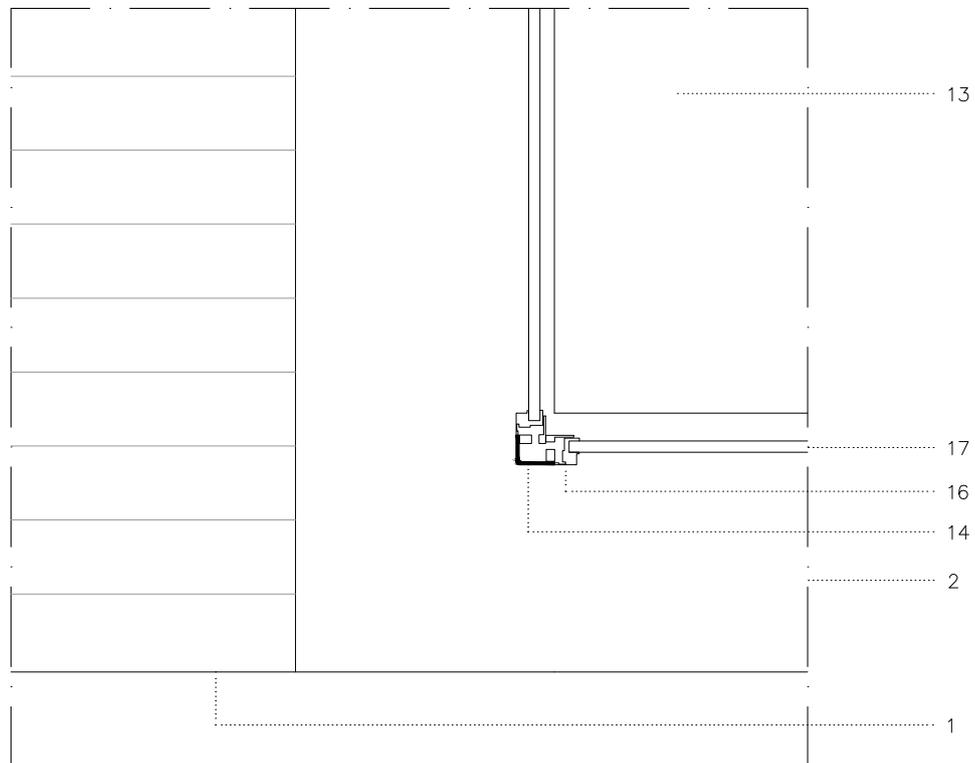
Pormenor do vão de entrada do atelier. Figura 66. Pormenor da uma esquina do atelier
